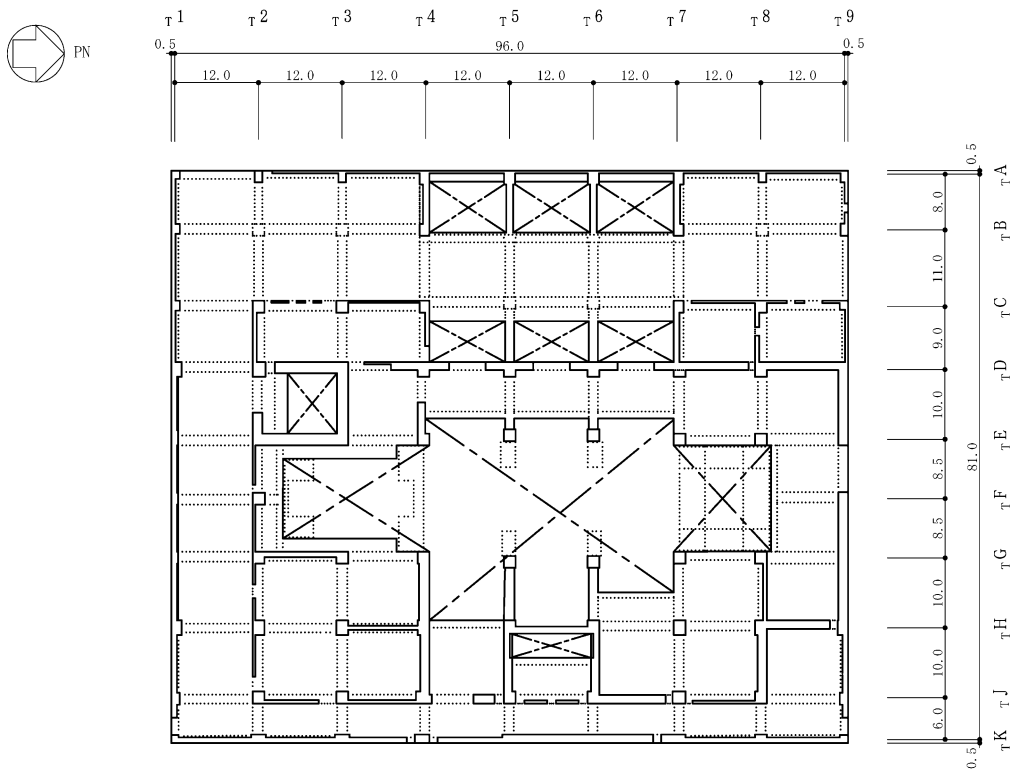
タービン建屋の概略平面図 (1F, T. M. S. L. 12.3m) (3/6) (単位 : m)
